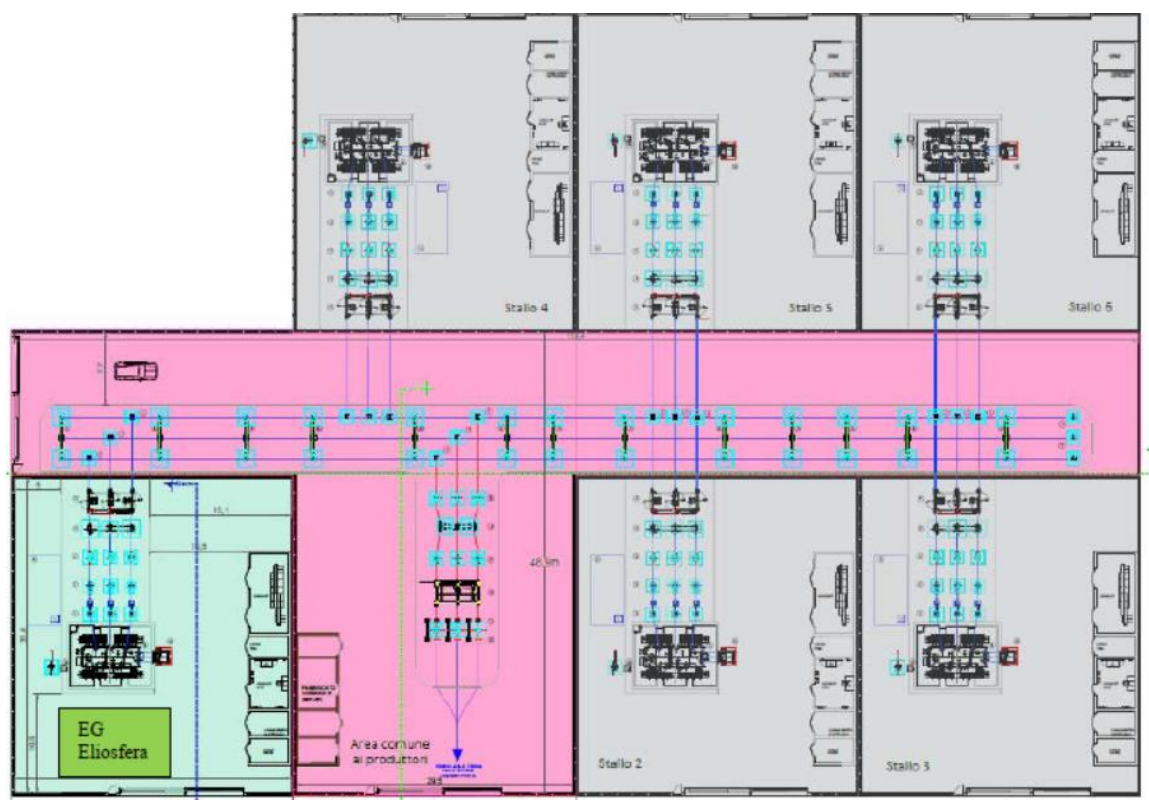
Stralcio planimetrico delle SSE e schema di connessione
